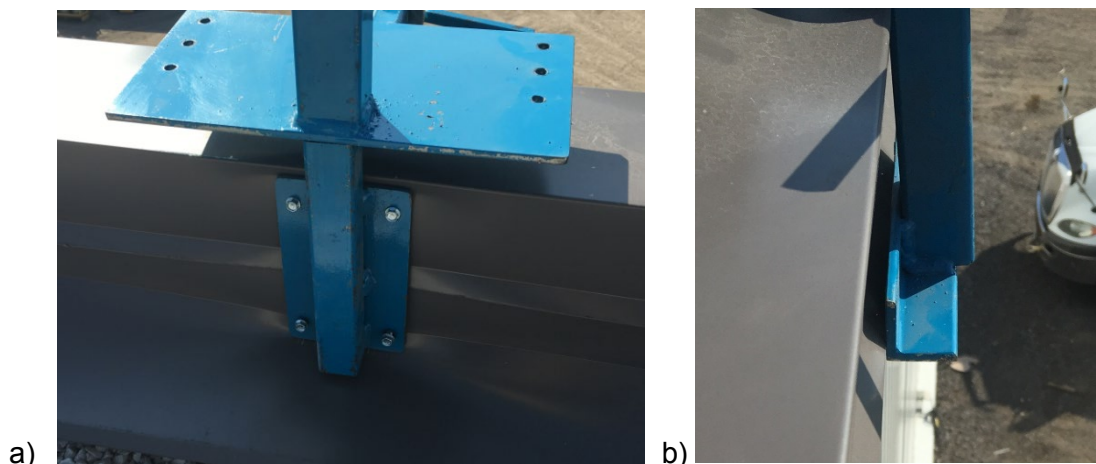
Garde-corps 1 testé sur le terrain, (a) fixation en façade du parapet (4 vis), (b) avec le serre-parapet.
